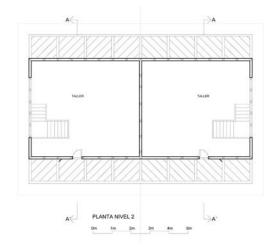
Planta 1º piso. Levantamiento A. Aedo; F. Catalán (fuente: Pablo Miranda).
